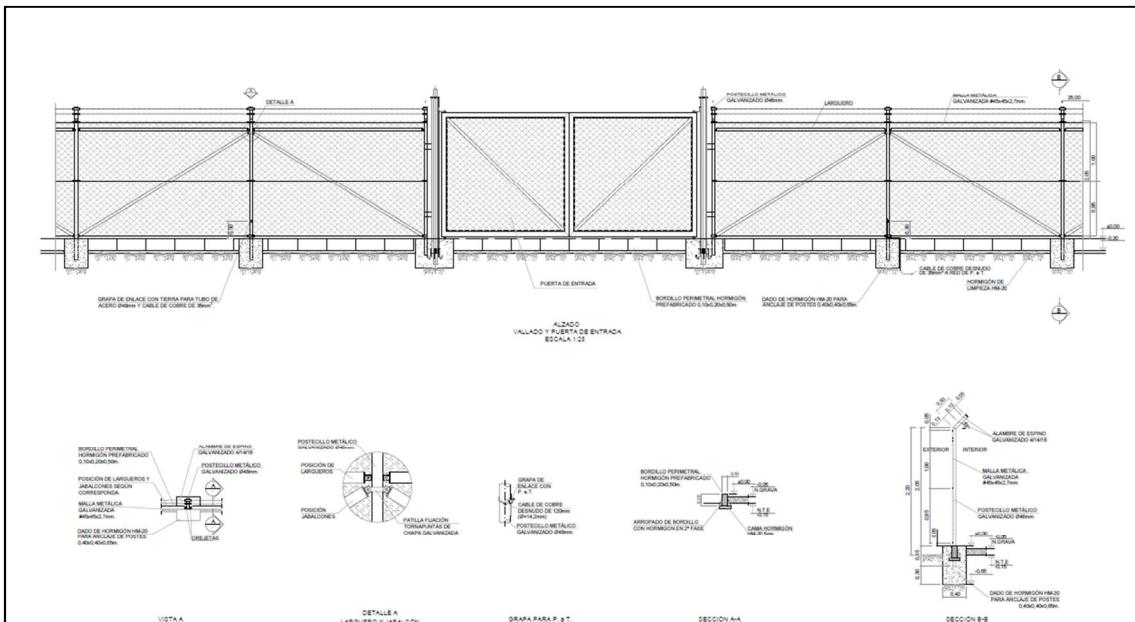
Detalle del vallado perimetral de la planta de almacenamiento de energía BESS Retuerto.
